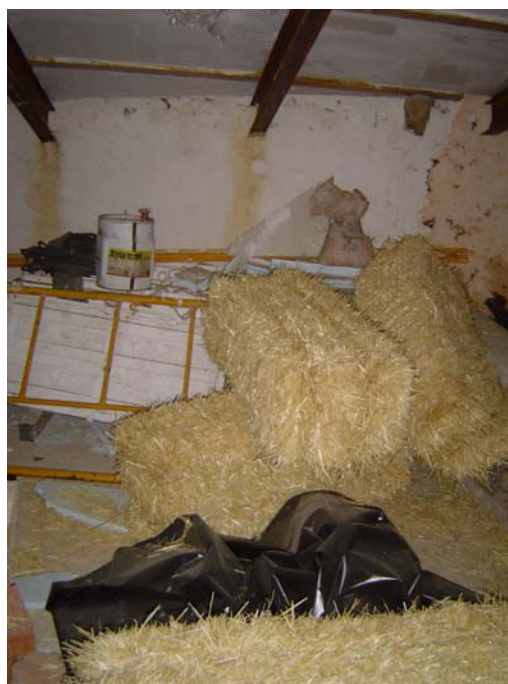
Balas de paja utilizadas para la construcción de la pared
